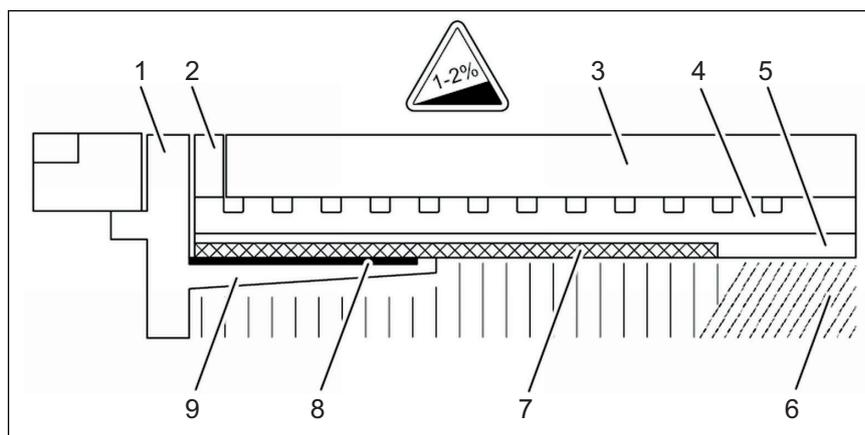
Esquema de sistema de impermeabilización compuesto: pendiente del pavimento mín. de entre el 1 y el 2%
